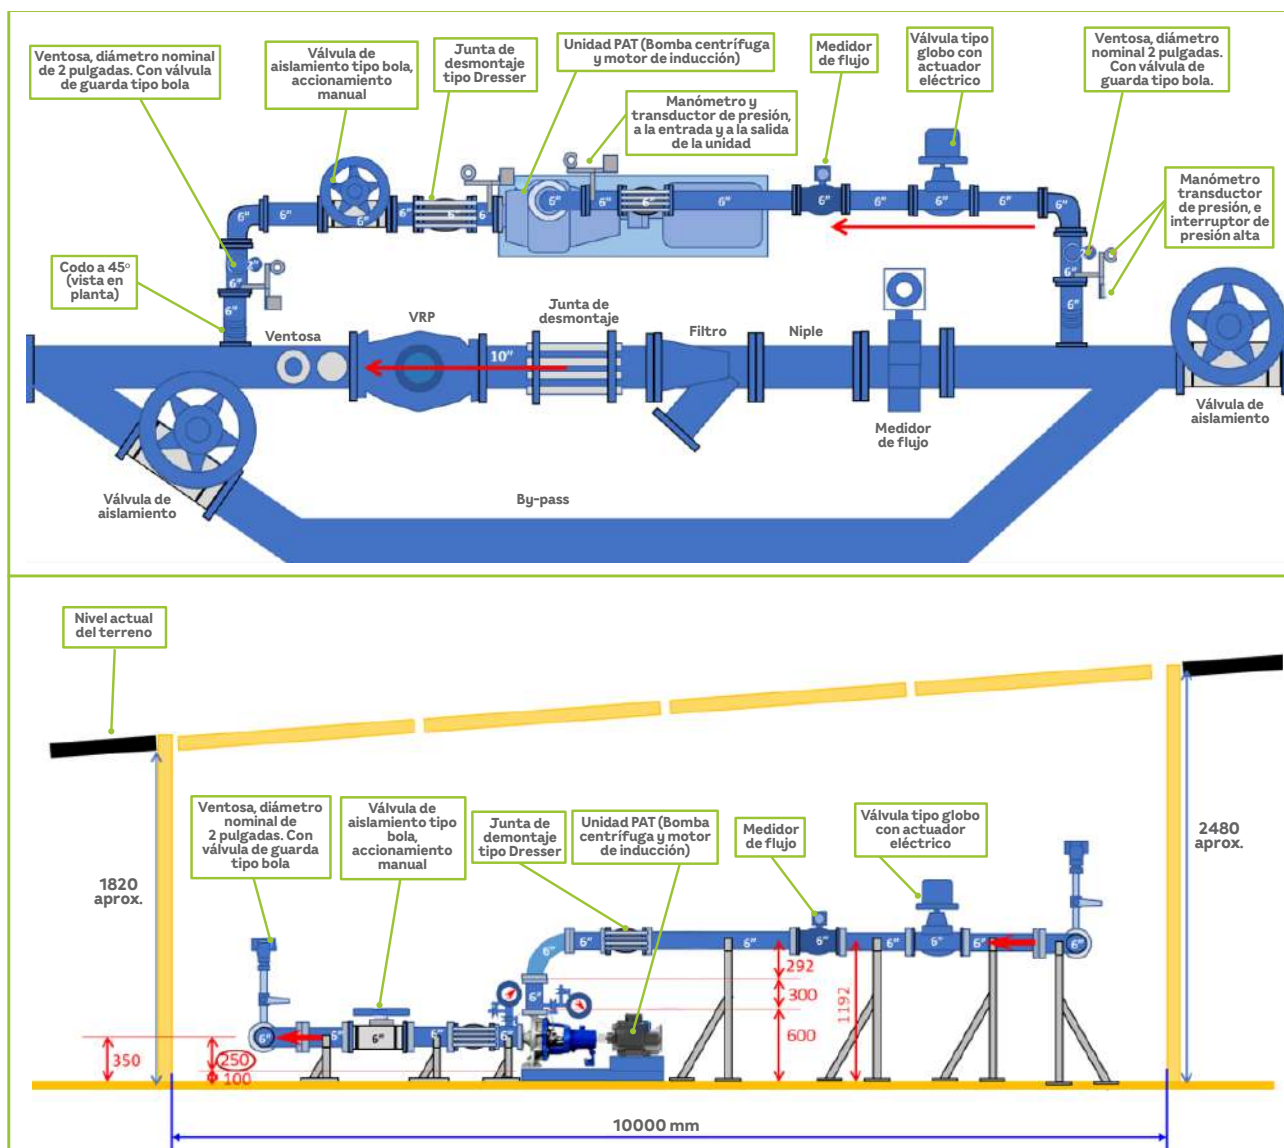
Configuración del Sistema PAT de 25kW en válvula VRP La Estrella (Vista de Planta y de Perfil).
